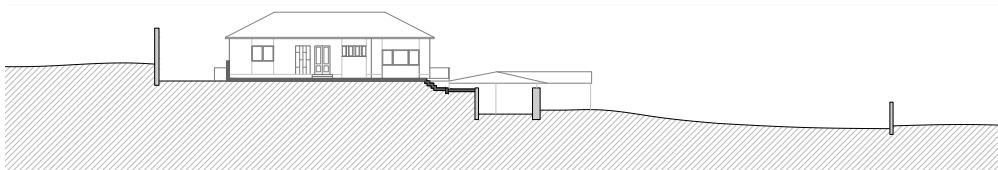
| Planta, cortes e alçado | Pré-existência em Zebreiros | Desenhos sem escala
